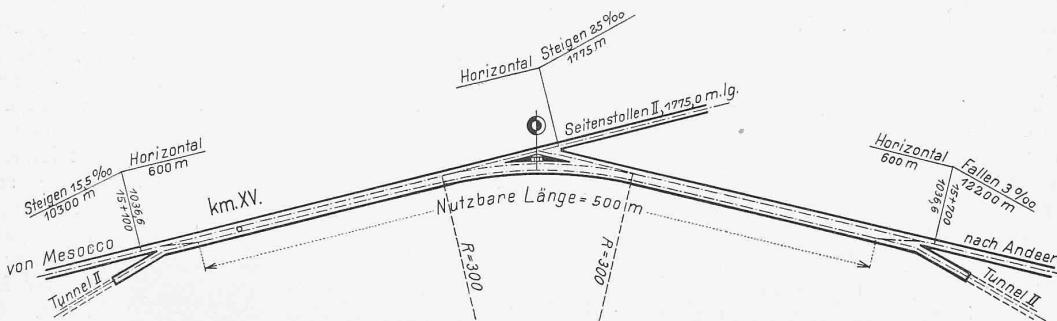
Lageplan der Tunnelstation bei Seitenstollen II. — Masstab der Längen 1 : 5000.
